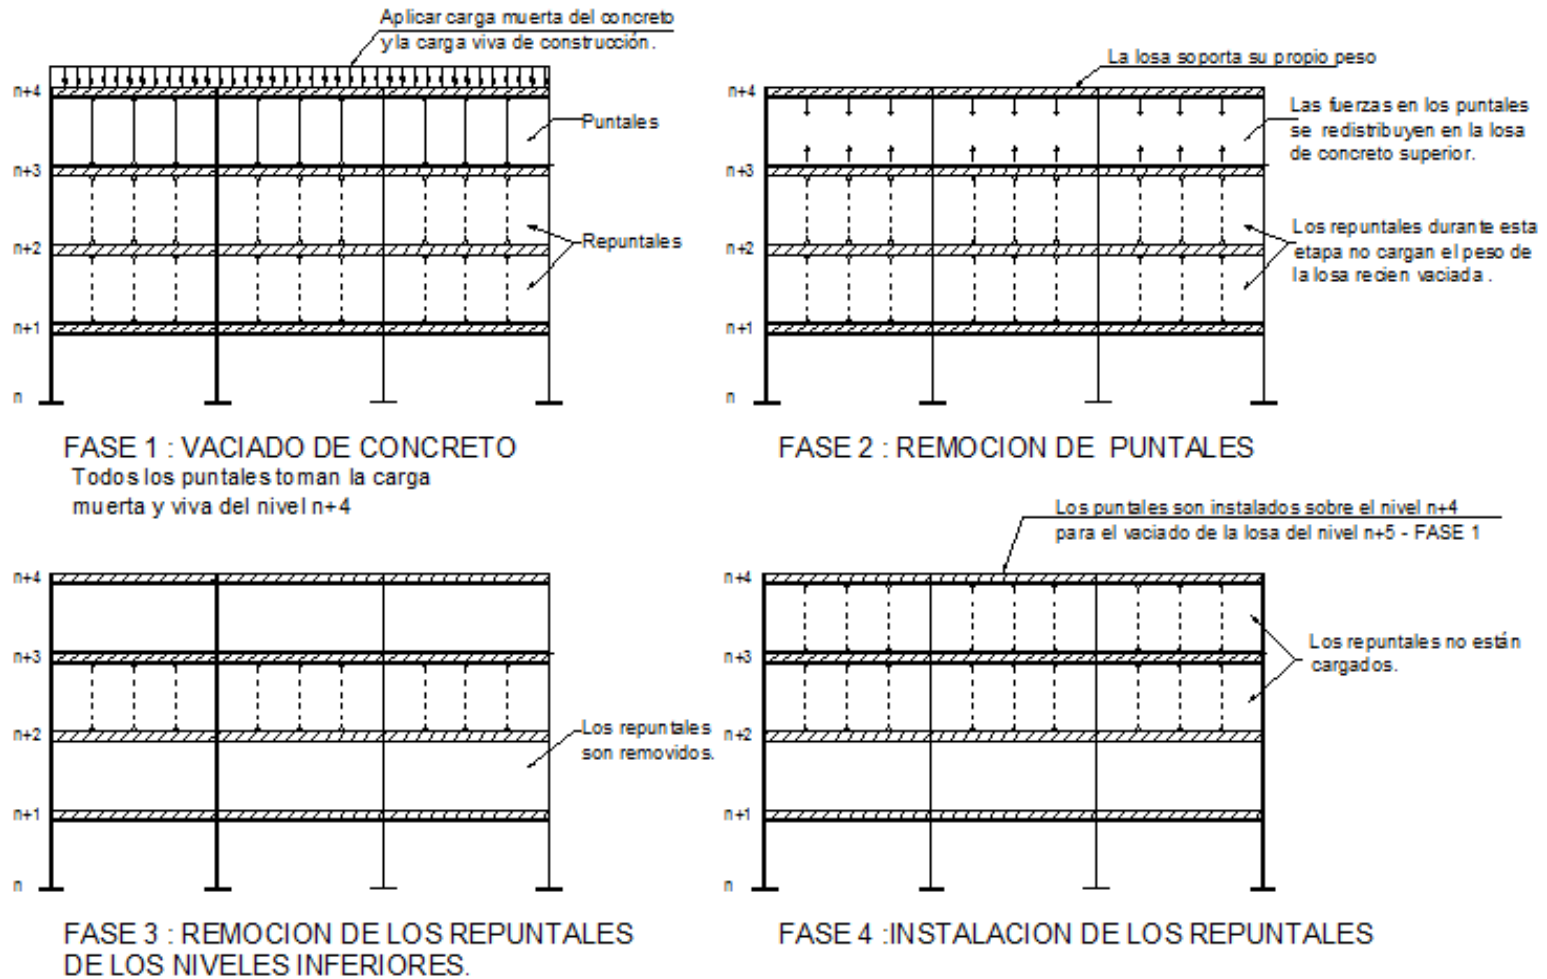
Fases típicas de construcción para edificios de concreto armado según la ACI 347.
